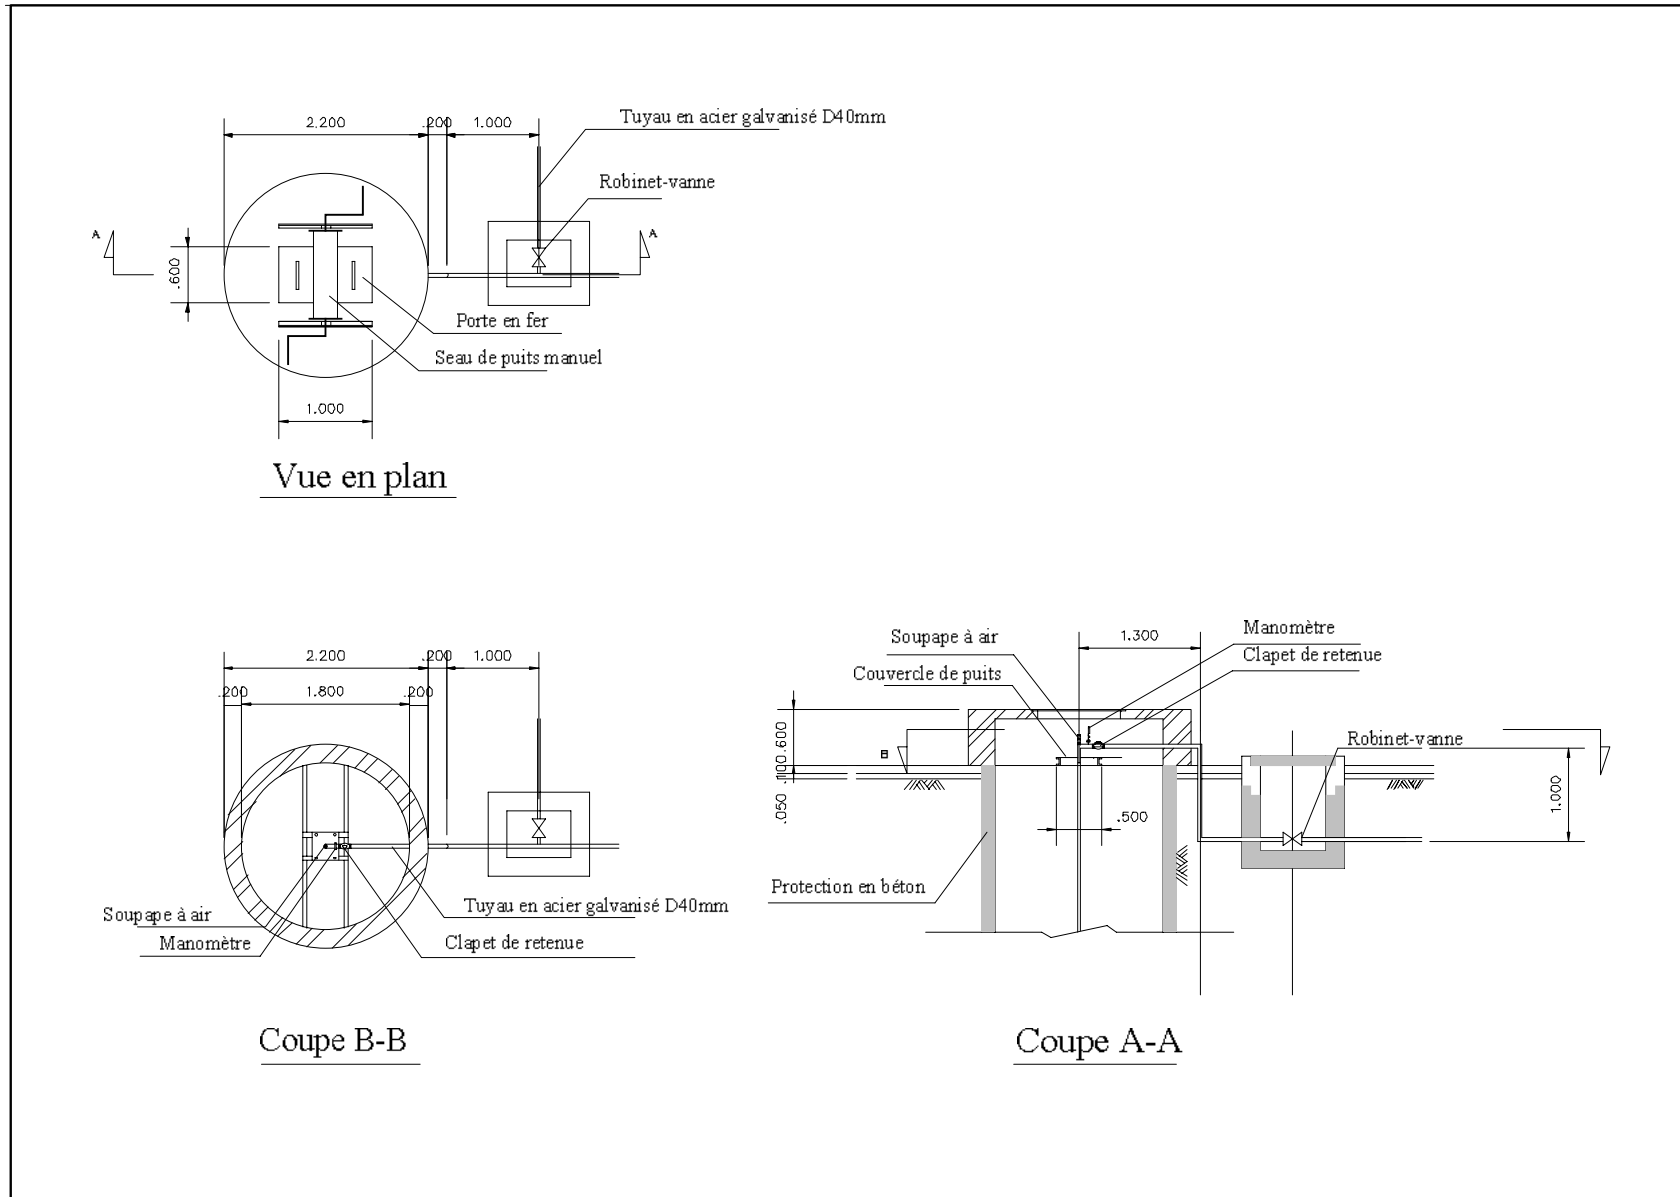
Plan détaillé des installations de point d'eau
